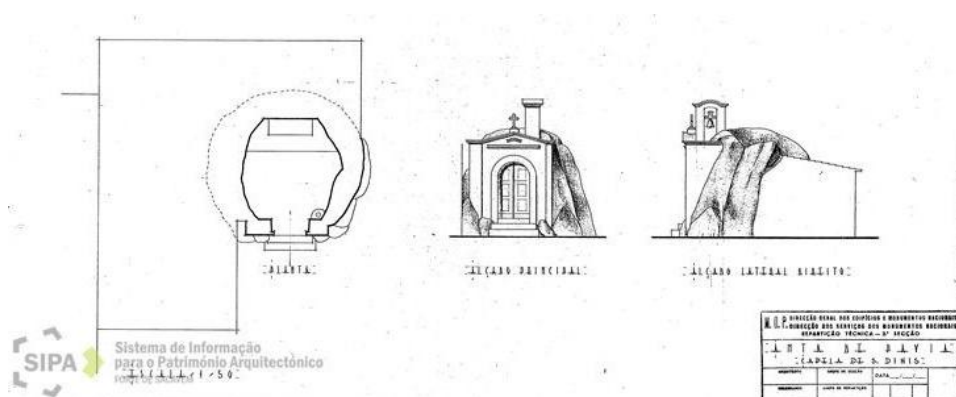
Planta da Capela São Dinis ou Dionísio, Pavia (década de 50)
